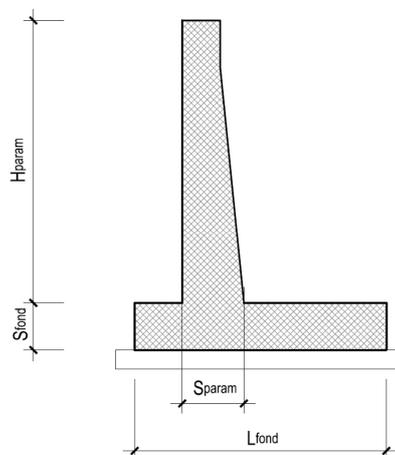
Sezione trasversale tipo muro di sottoscarpa
